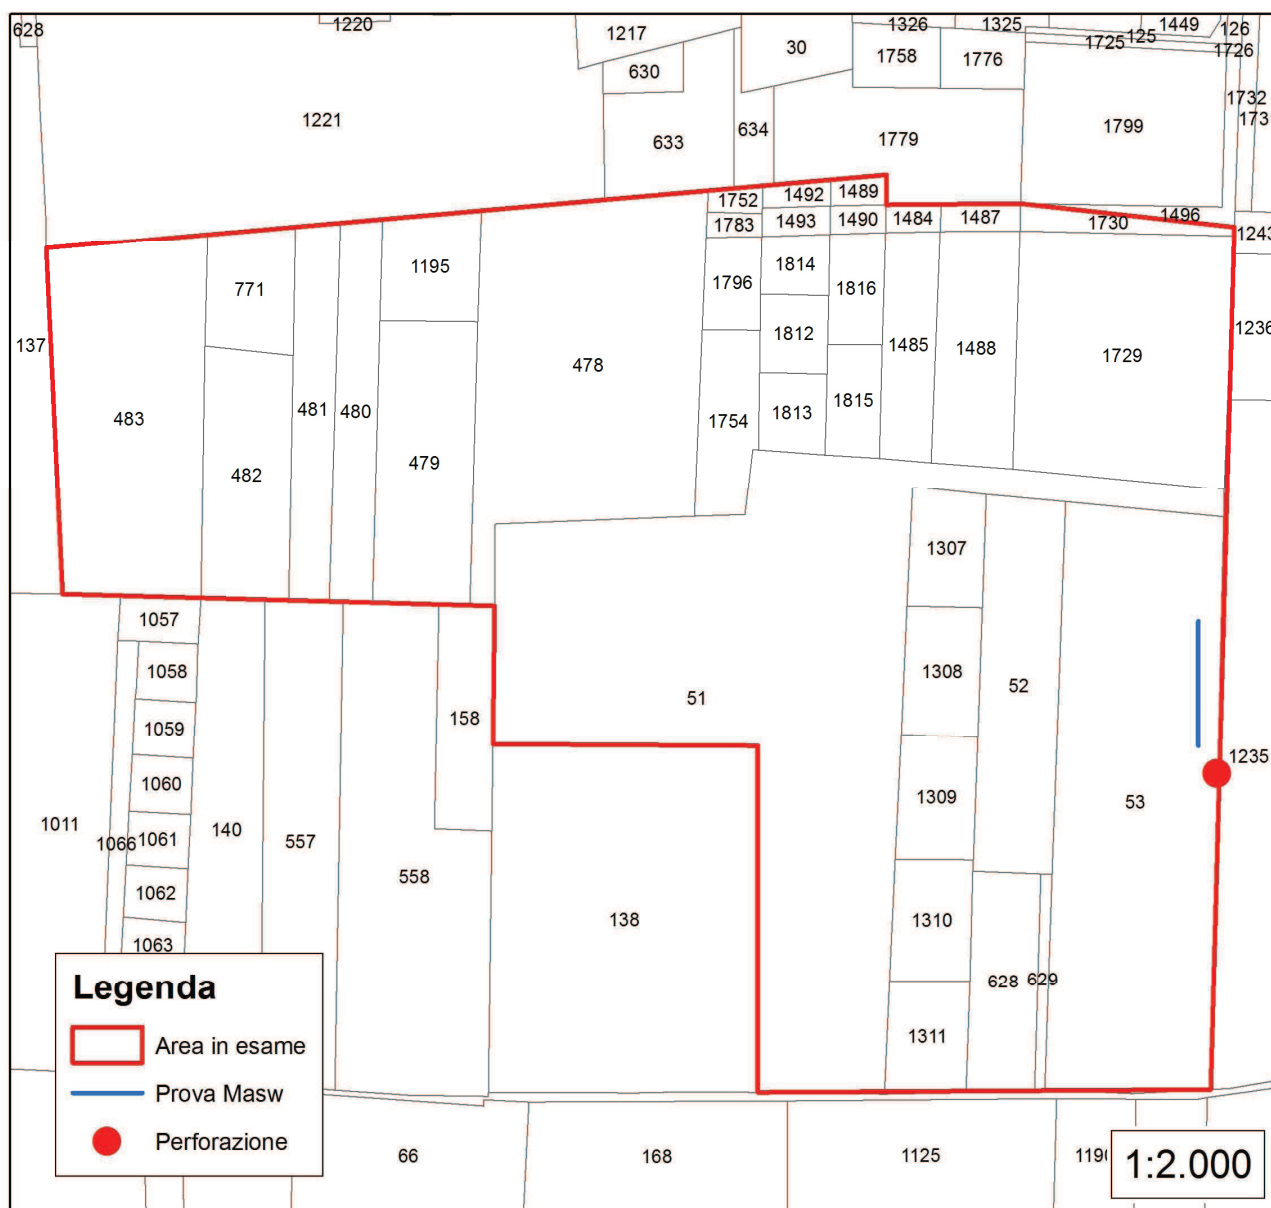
Stralcio planimetrico catastale 1:2000 – Foglio n.2
